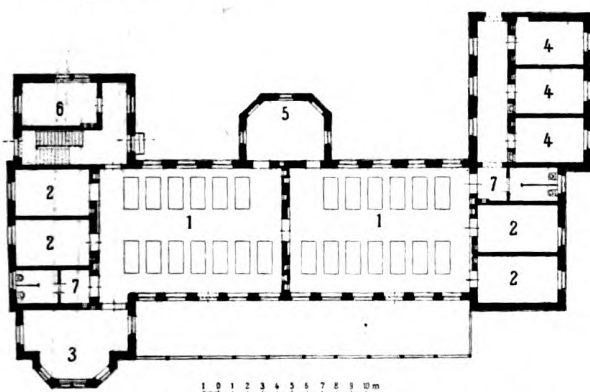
Grundriss des Ueberwachungshauses für unruhige Kranke. Nr. 22 des Planes.
